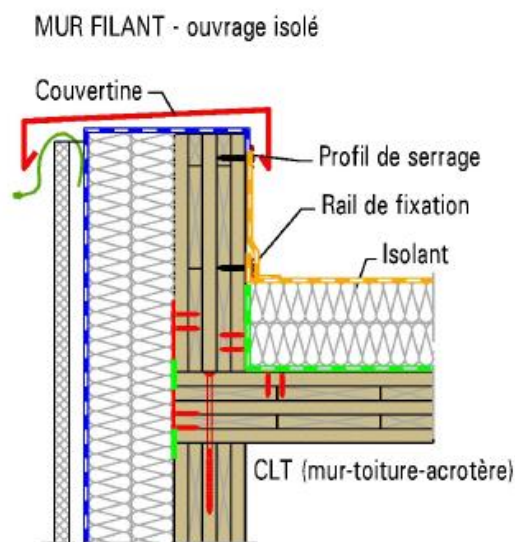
Détail acrotère étanchéité autoprotégée. Toiture non accessible
